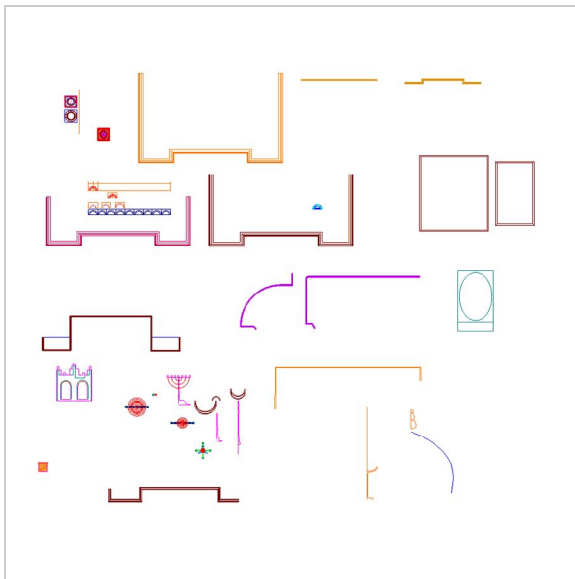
Bauteile und Bibliotheksobjektquellen der Heiligen Lade im Grundriss.
